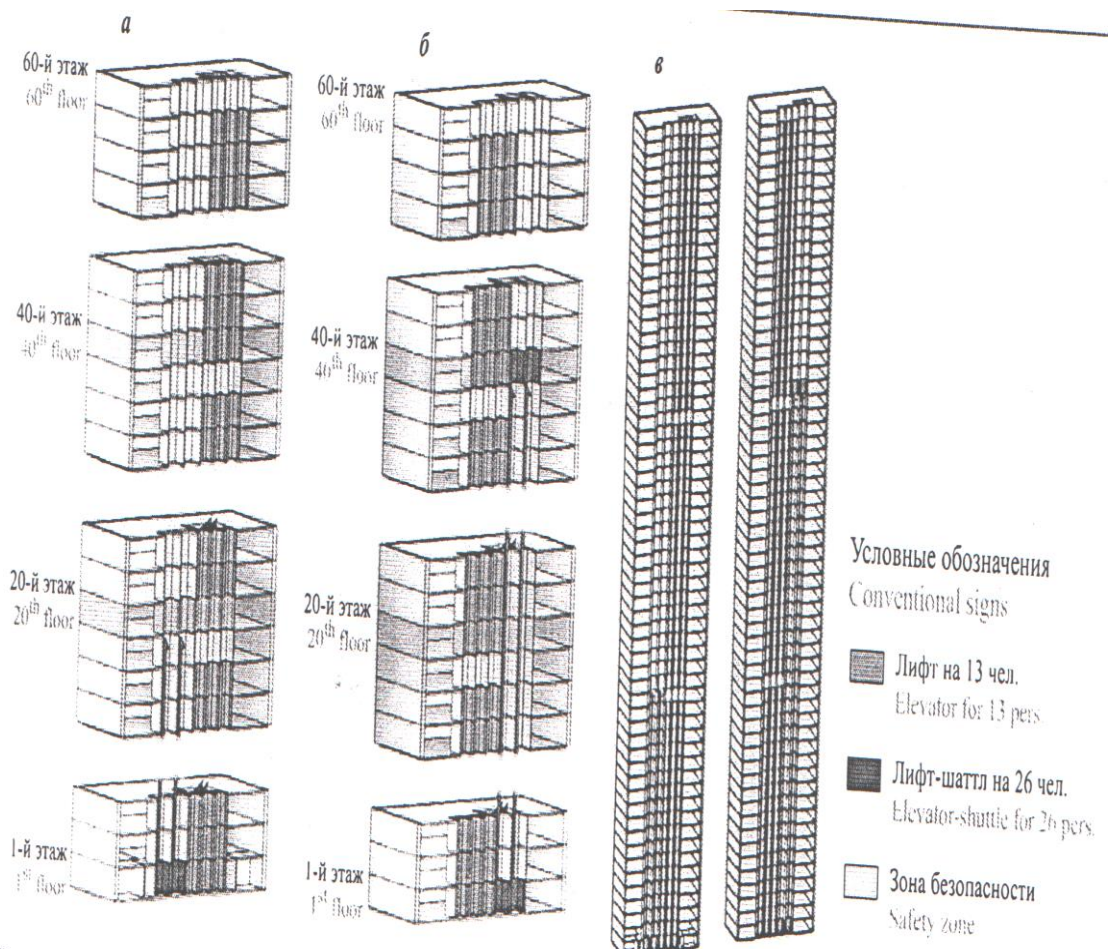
Розріз будівлі офісного центру: а) рух ліфта-шаттла з 1 по 20-й поверхи; б) рух ліфта-шаттла з 20 по 40-й поверхи; в) загальний розріз будівля для обох випадків
